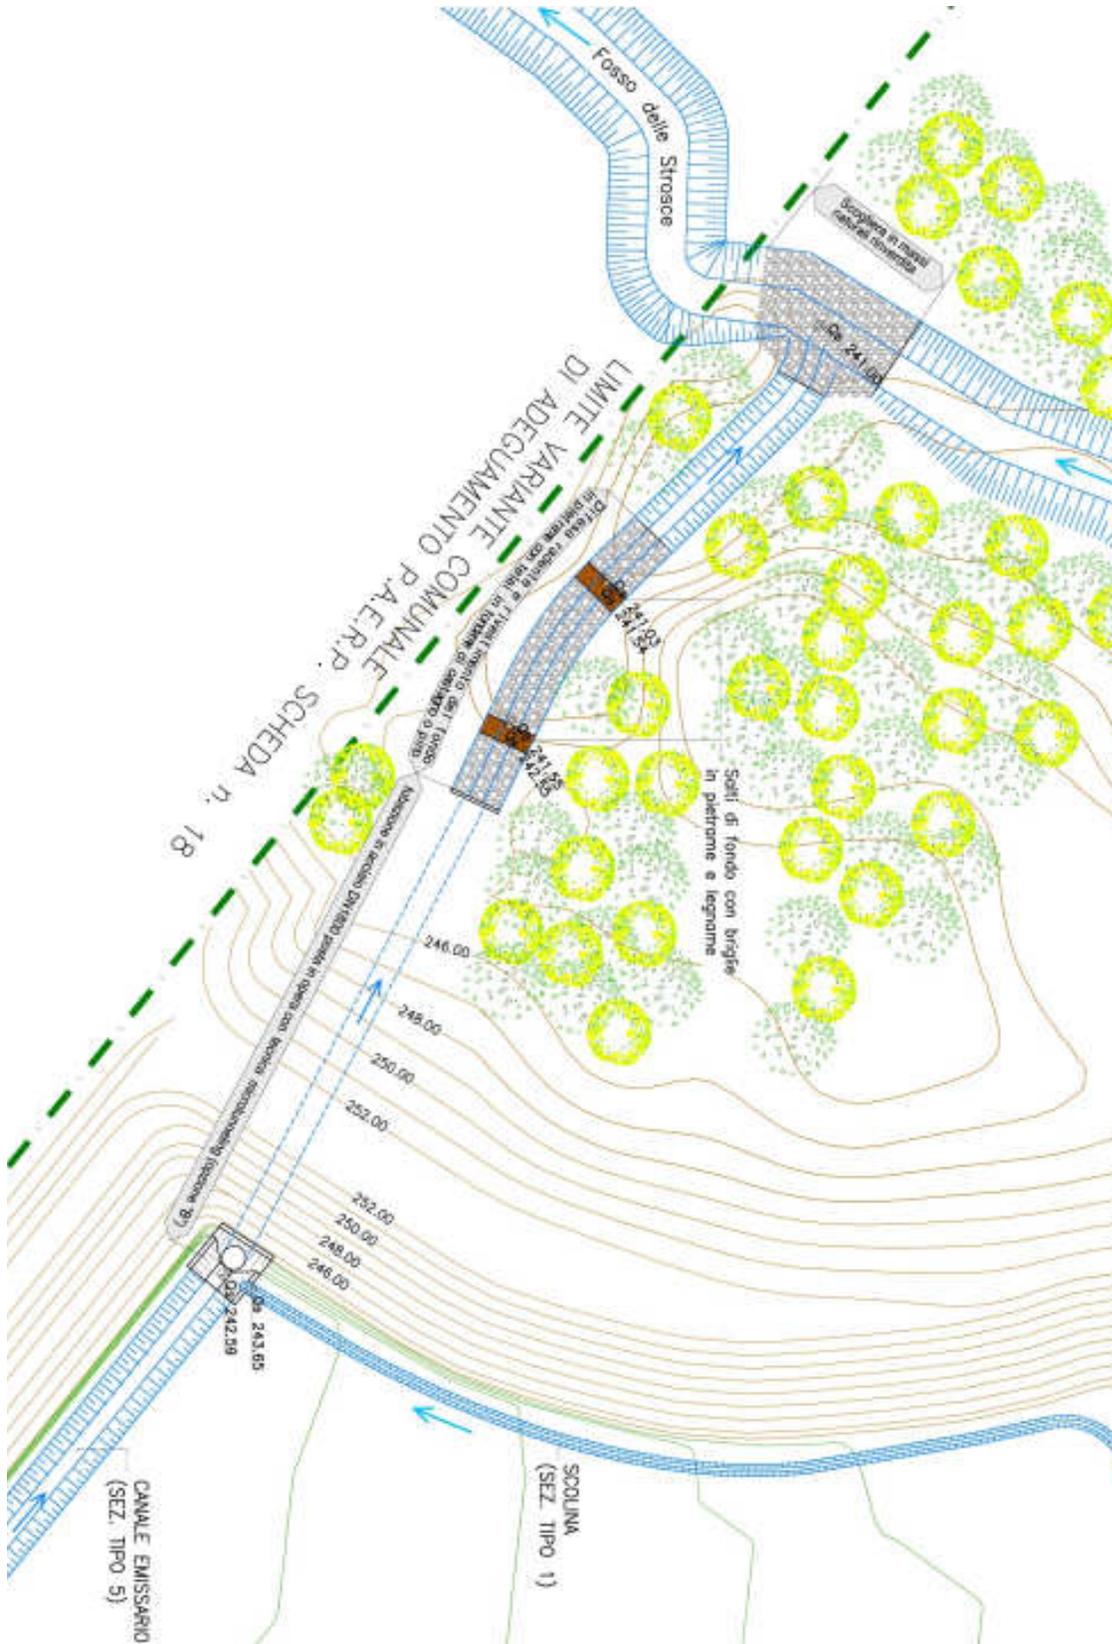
Planimetria del canale di scarico del reticolo di progetto e opera di sbocco nel borro delle Strosce nella "Opzione B".
